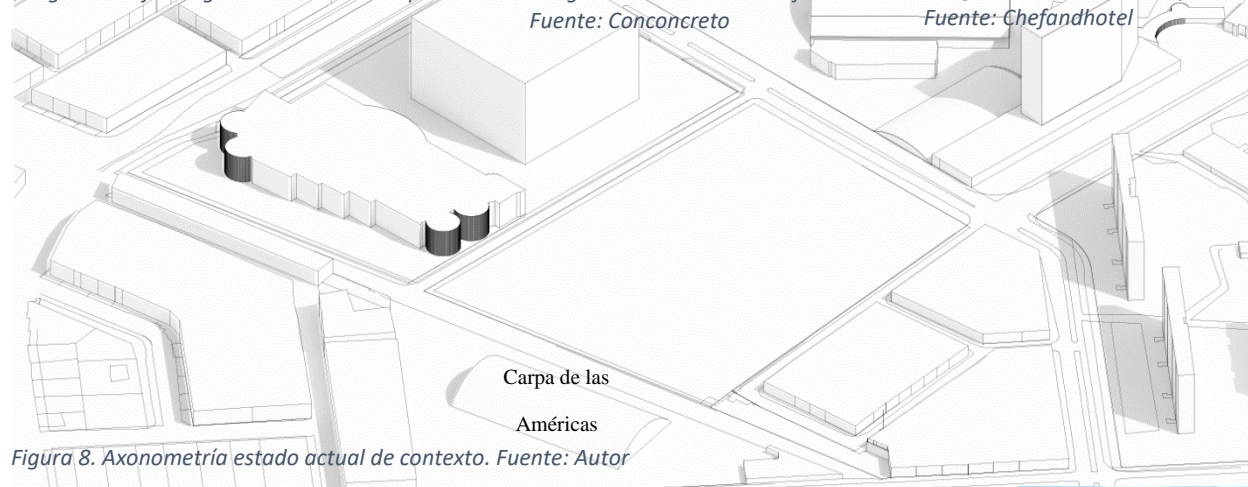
Axonometría estado actual de contexto. Fuente: Autor
